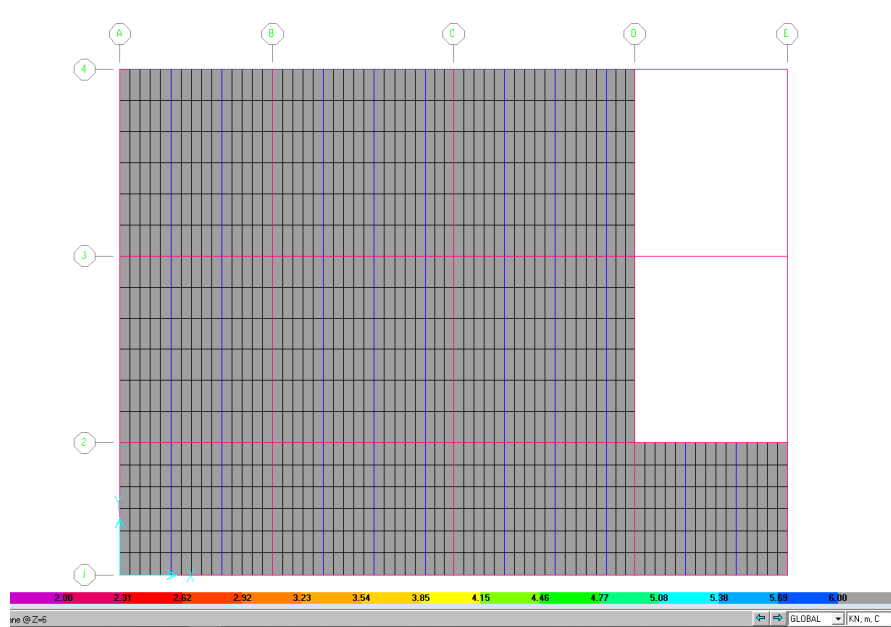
Planta nivel intermedio módulo de acceso estación 19 costado nor oriental aplicación de la carga viva (6,0 kN/m<sup>2</sup>)
